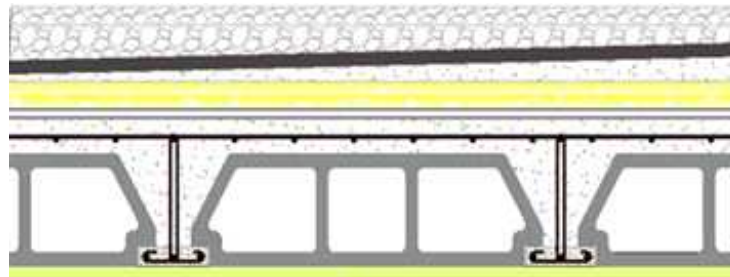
Composants d'un plancher terrasse en corps creux.
